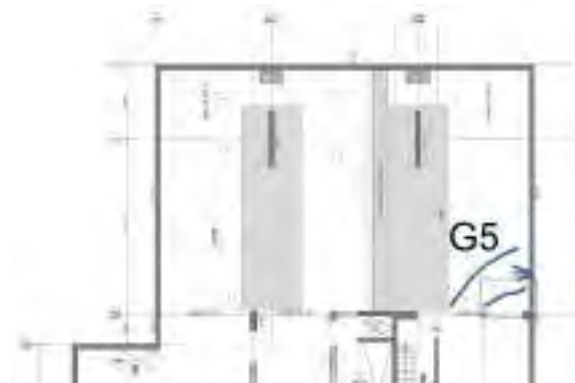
Grupo de Fisuras G5 (2)
